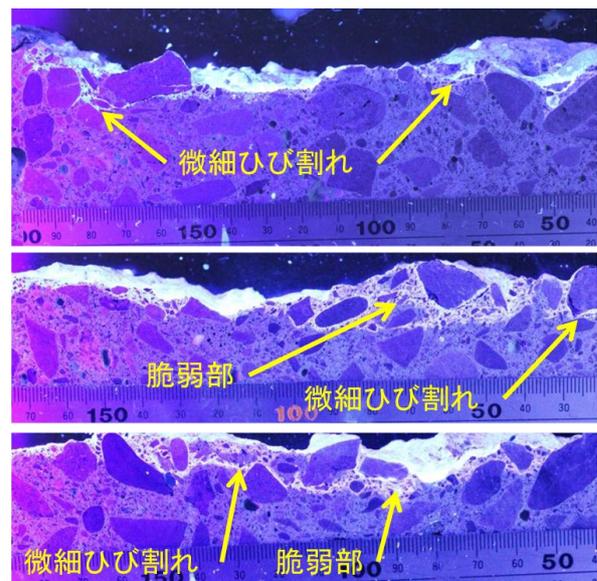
開発したエポキシ樹脂接着剤の脆弱部および微細ひび割れへの浸透状況
